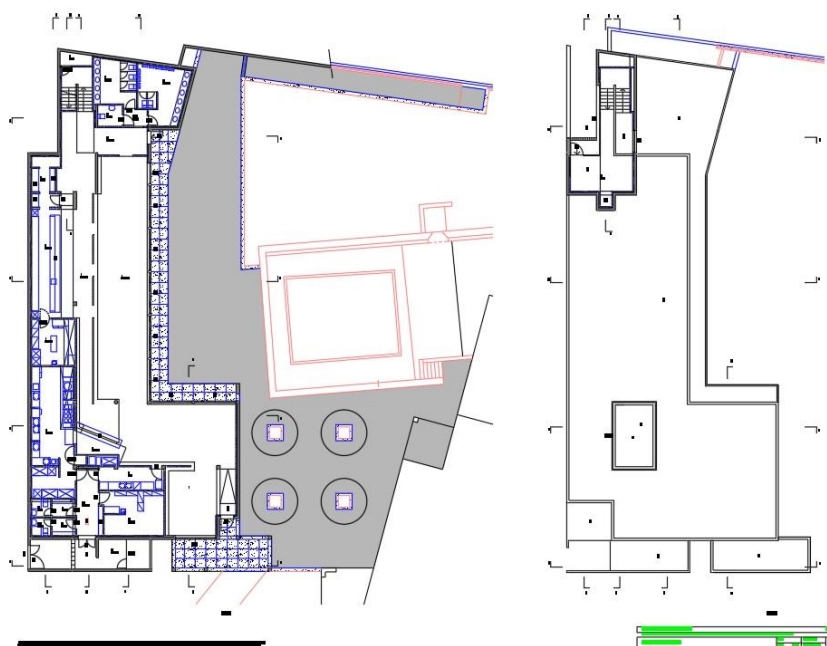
Planta de arquitetura em formato CAD do piso 0.
